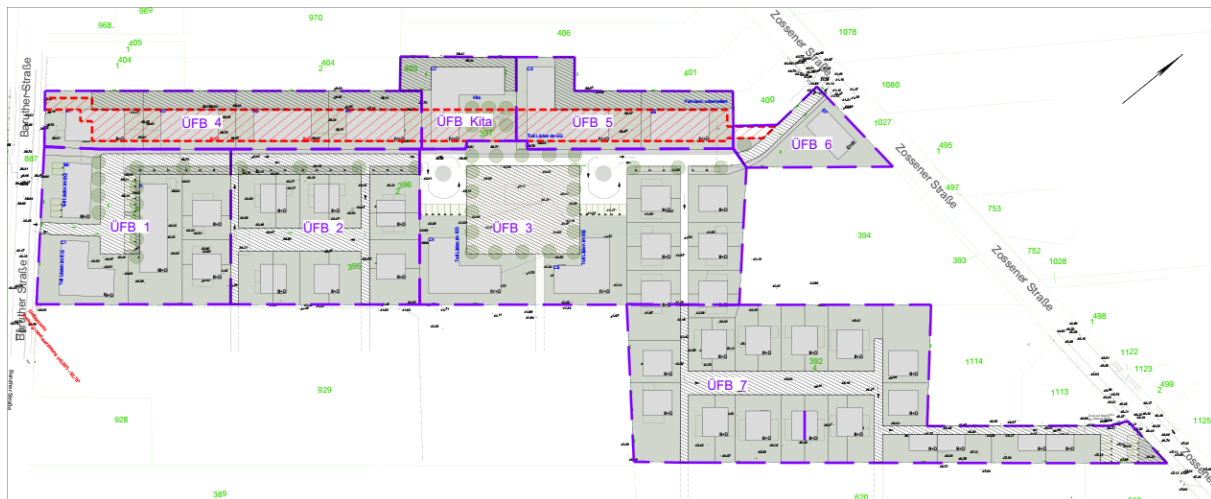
Ausschnitt Lageplan Überflutungsnachweis mit potenziellen Überflutungsflächen (schwarze Schraffur),
